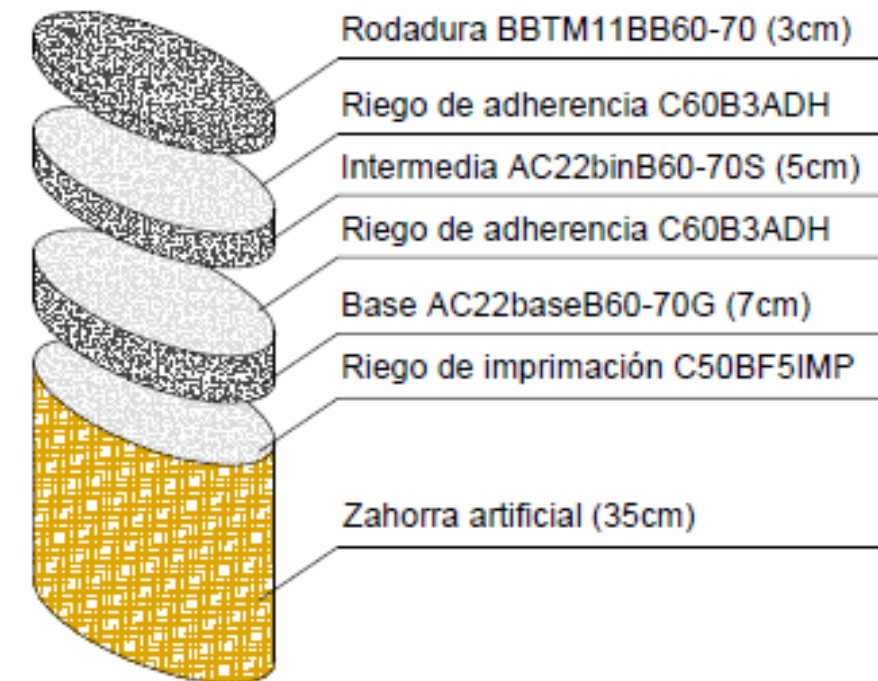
Paquete de firme calzada. Fuente: Elaboración propia.
